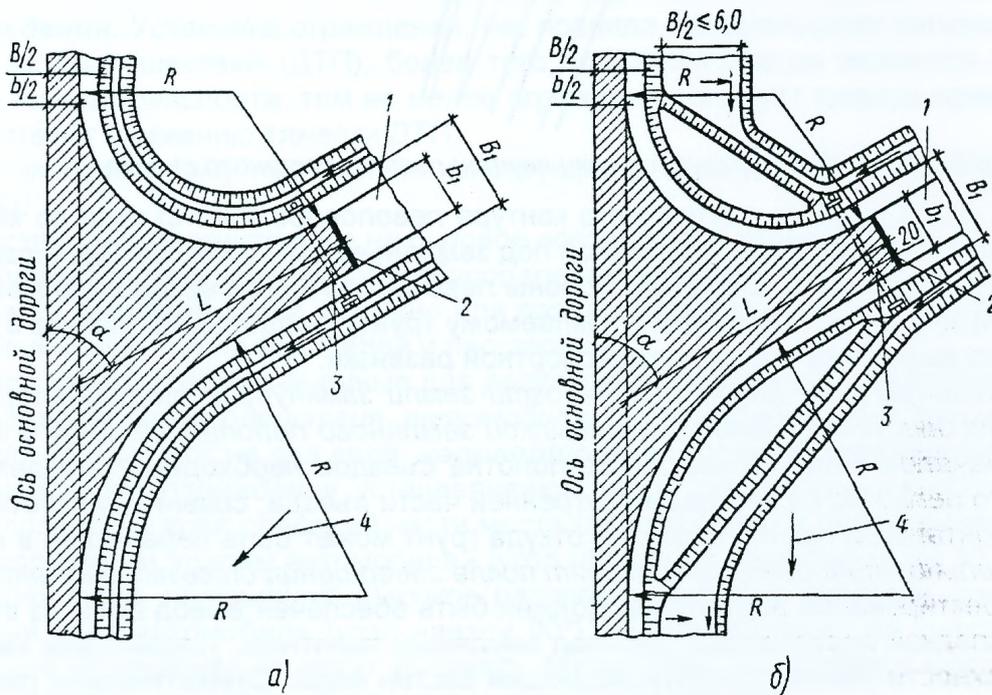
Схема отвода воды на съездах: а – с выпуском воды в кювет; б – с выпуском воды в кювет-резерв; 1 – существующие покрытия; 2 – граница съезда; 3 – железобетонная труба; 4 – направление стока
